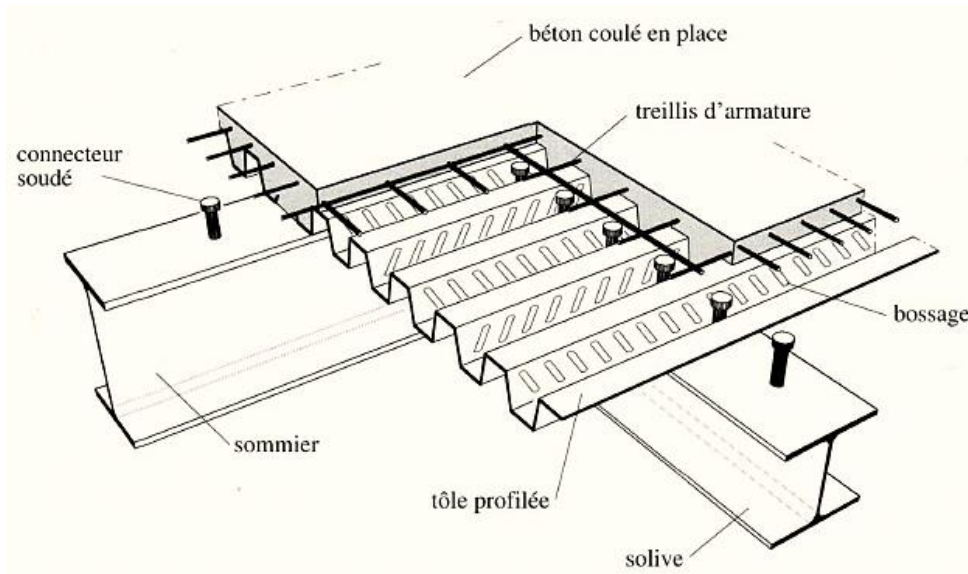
Plancher mixte avec connecteurs acier-béton [26].
